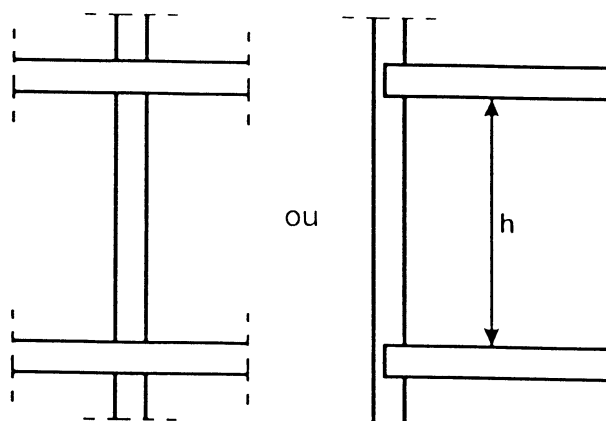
Liaison avec encastrement assurée par les planchers ou la toiture
